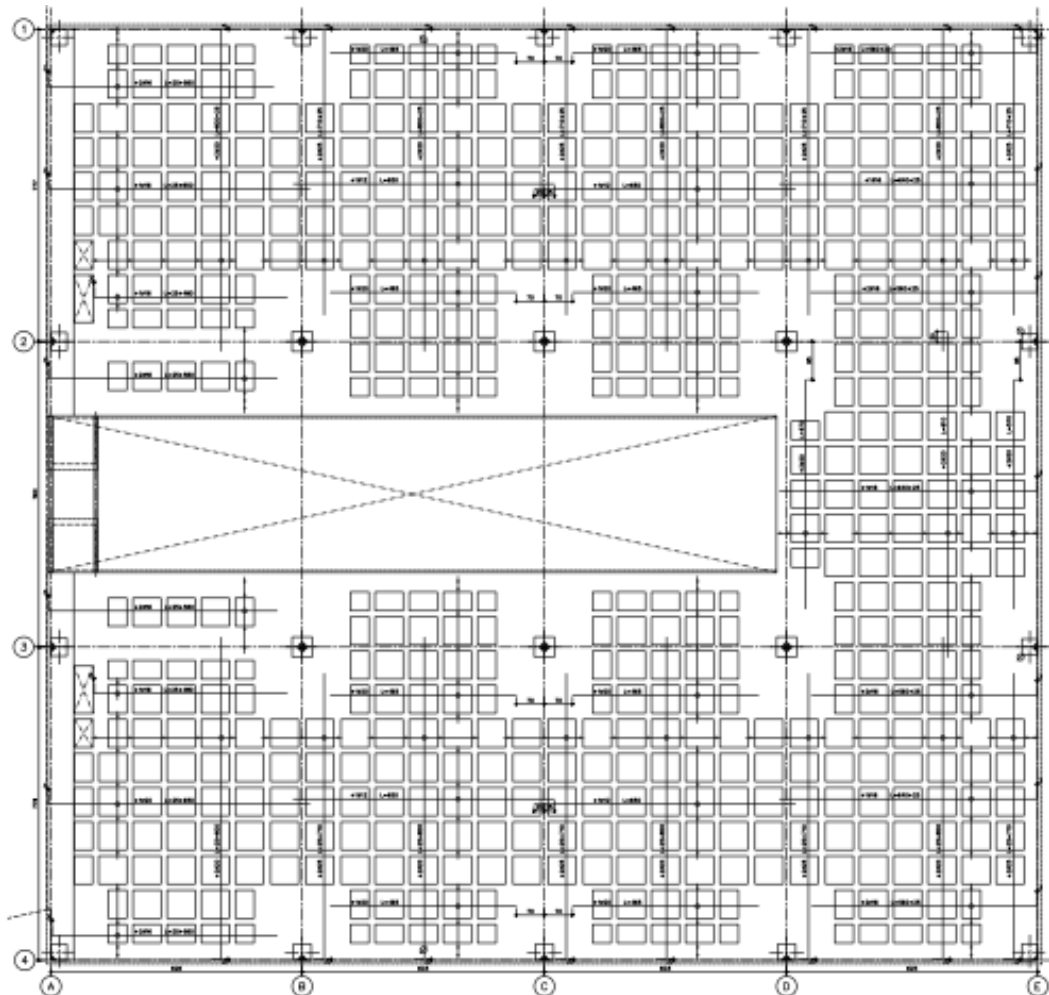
Vista en planta del nivel 1 del edificio K2M (Fuente: Planos estructurales del edificio K2M)
